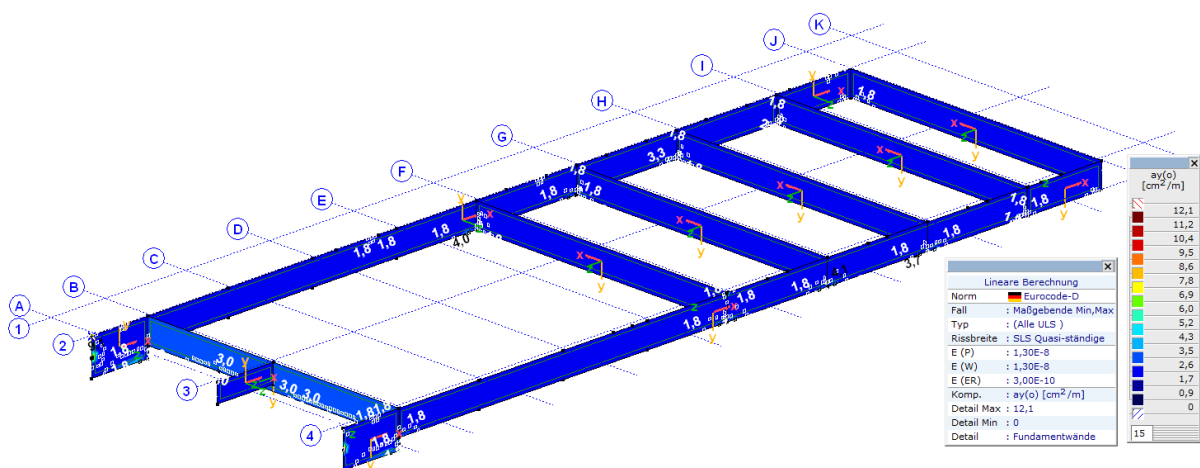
Berechnete Bewehrung innen in lokaler y-Richtung ay(o) (vertikal)
